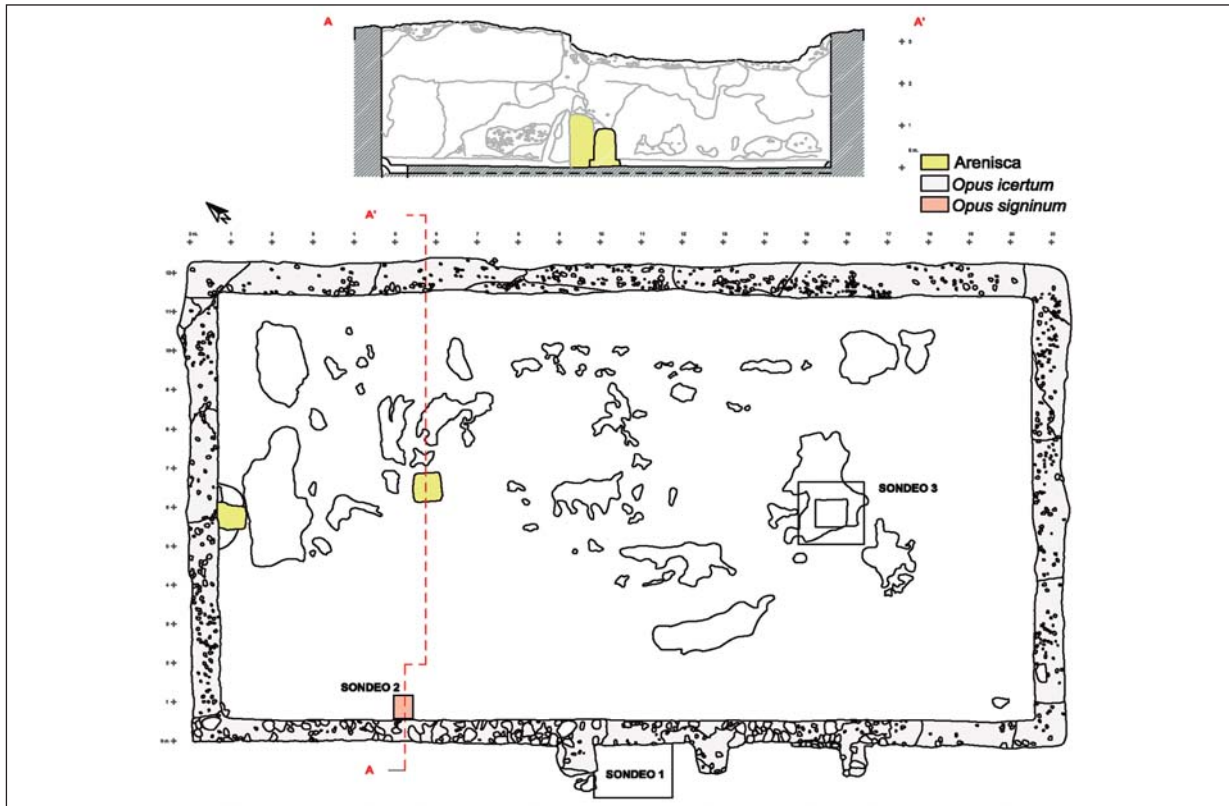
Planta y alzado septentrional de la balsa de acopio (EHA 1).
